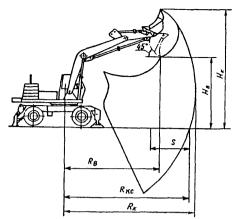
Рабочие размеры забоя полноповоротного экскаватора,оборудованного прямой лопатой
